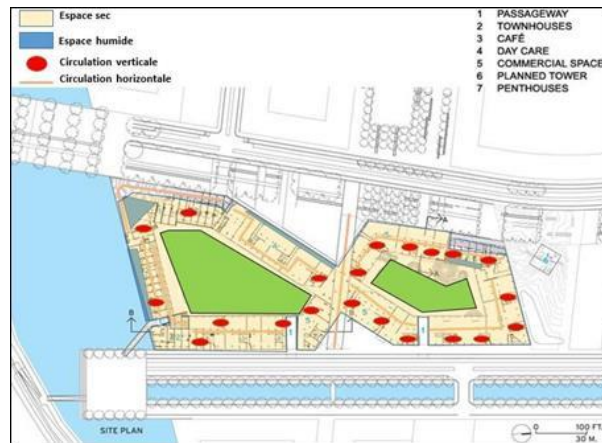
plan du R.D.C, source : <https://www.archdaily.com/>
